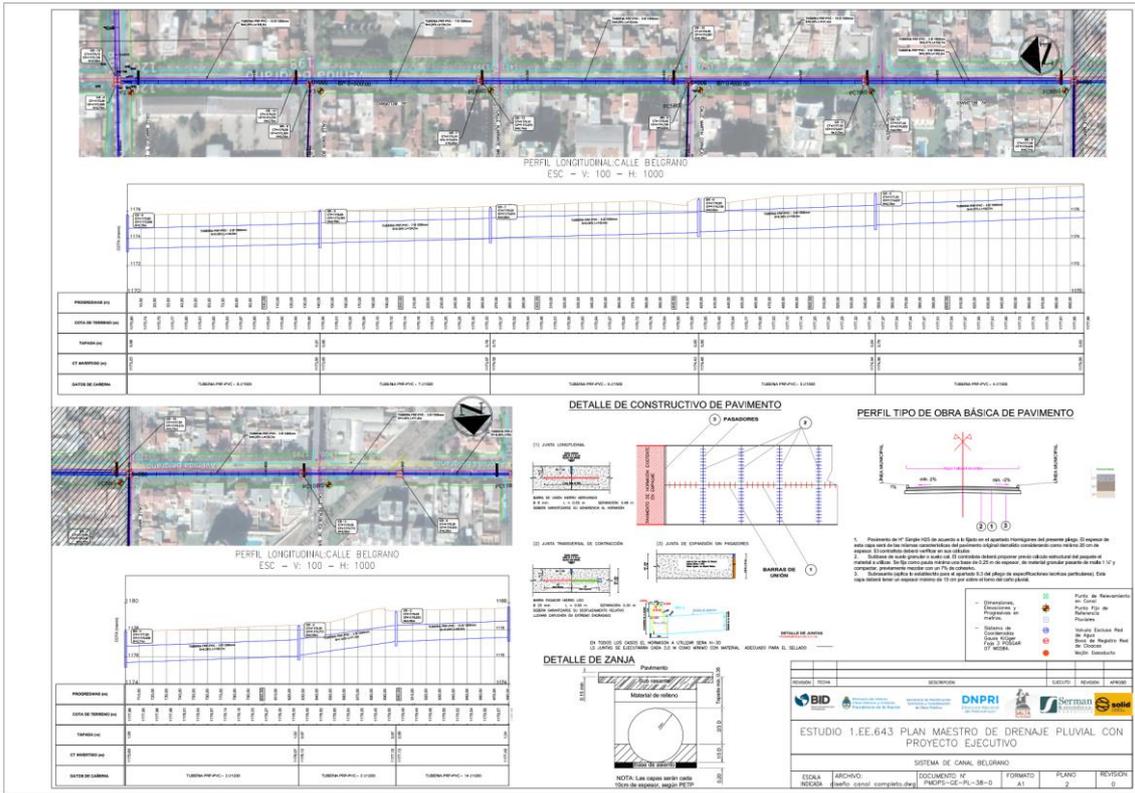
Plan Maestro de drenaje Pluvial – Canal secundario calle Belgrano
